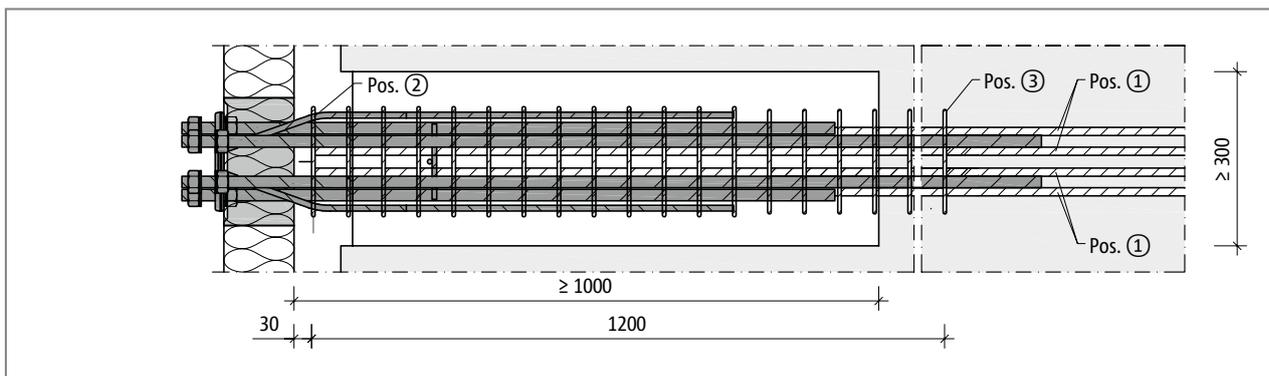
Schöck Isokorb® XT Typ SK-MM2: Bauseitige Bewehrung bei Fertigteilbauweise, Grundriss
